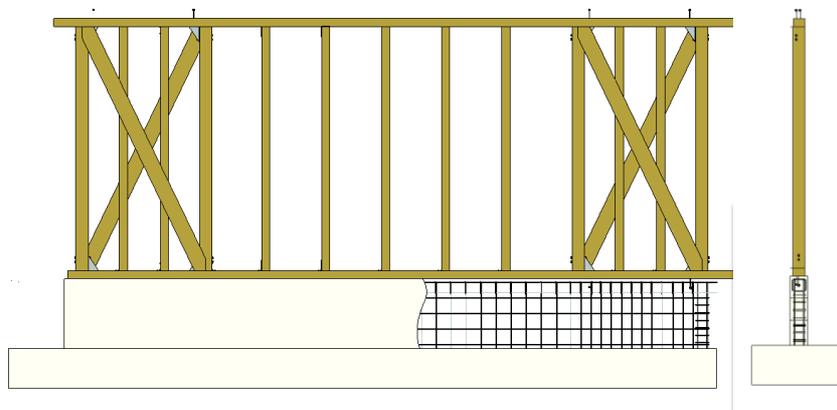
Exemple de panneaux de contreventement PST sur fondation de type semelle filante, en élévation et en coupe transversale.
